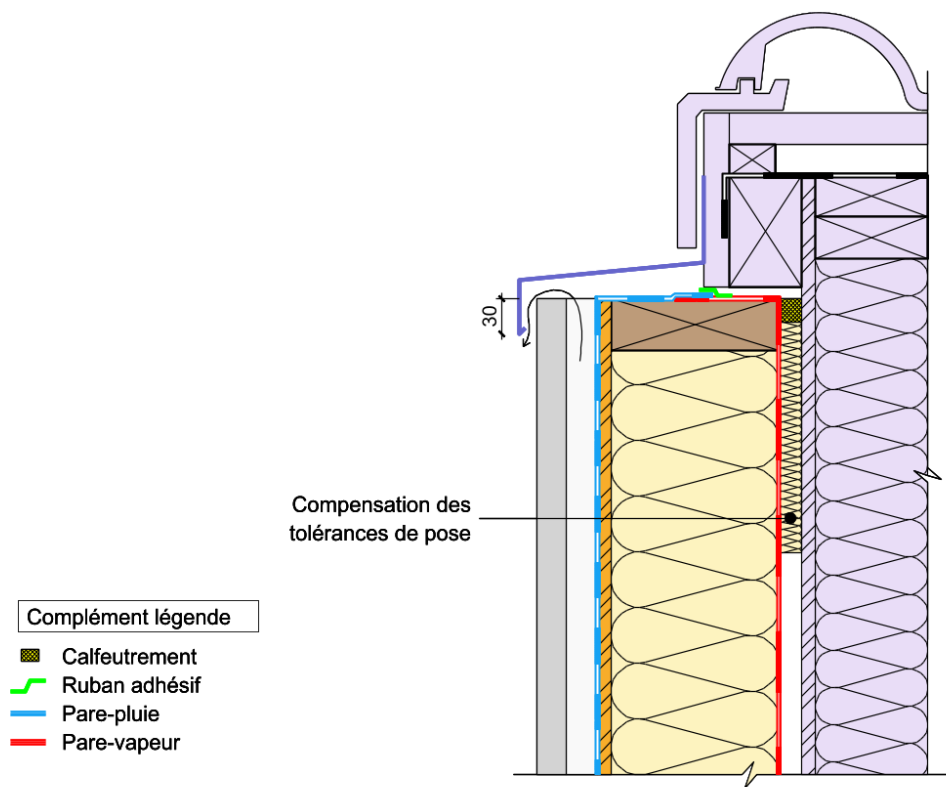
Raccordement en pignon sans débord (coupe verticale)
